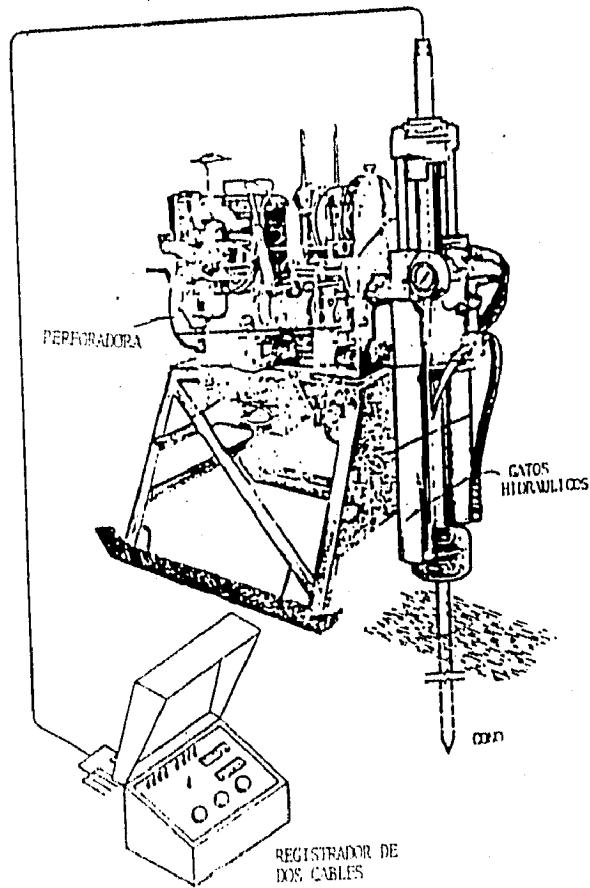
EQUIPO PARA PRUEBAS DE PENETRACIÓN DE CONO ESTÁTICO.
